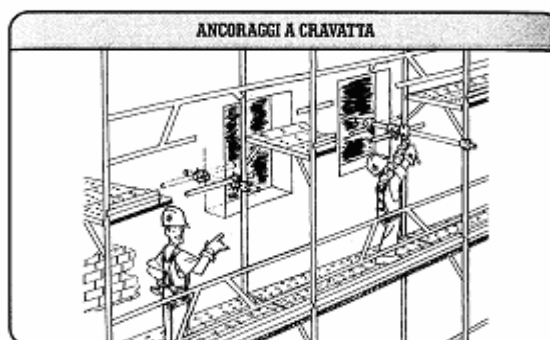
Esempio di ancoraggio strutturale “a cravatta”
